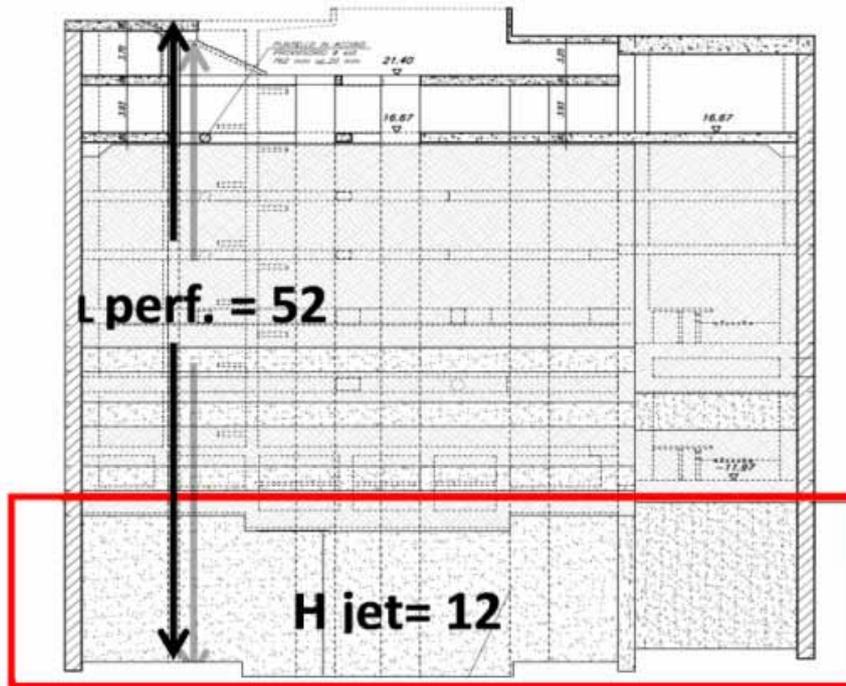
Schematizzazione del tampone di fondo della stazione Libia
